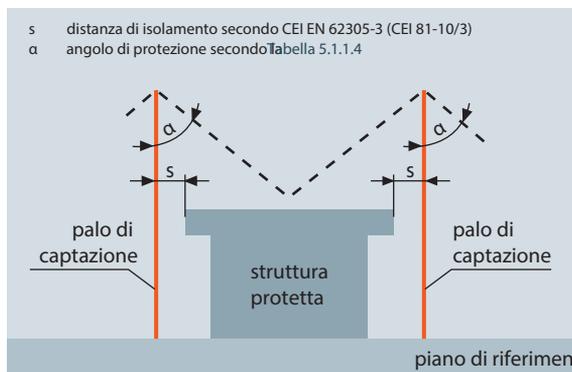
Sistema di protezione contro i fulmini isolato con due pali isolati secondo il metodo dell'angolo di protezione: proiezione su una area verticale
